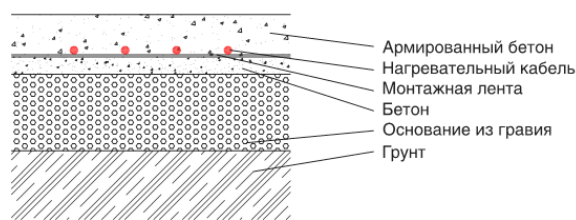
Схема розміщення нагрівального кабелю в бетонному покритті відкритої площини
